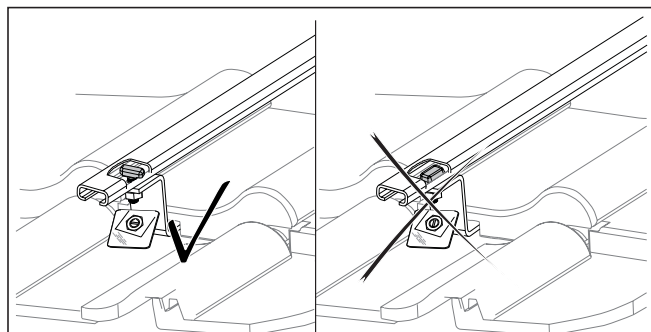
Hammerkopfschraube richtig verschrauben
